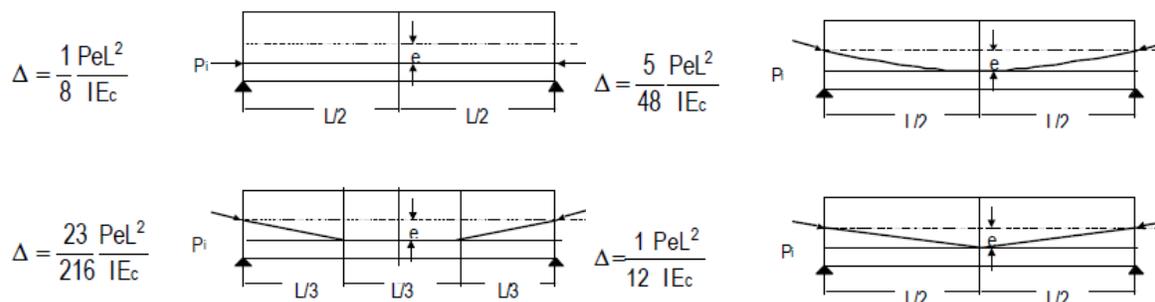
Deflexiones al centro del claro para algunos tipos de elementos pretensados simplemente apoyados.
